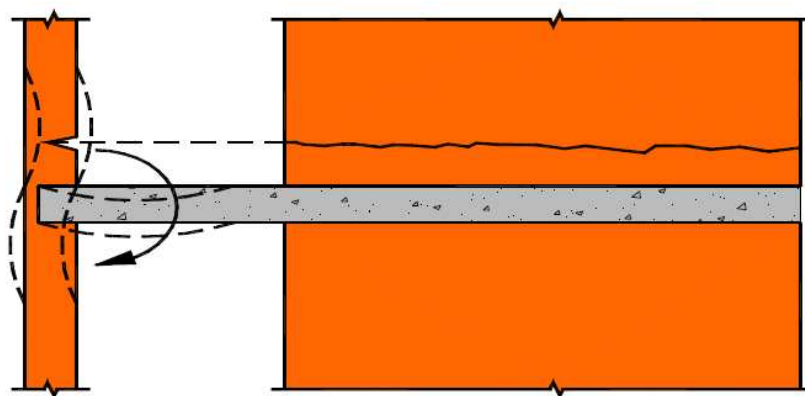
Fissuração devida à rotação do pavimento por excessiva deformação da laje. [10]
